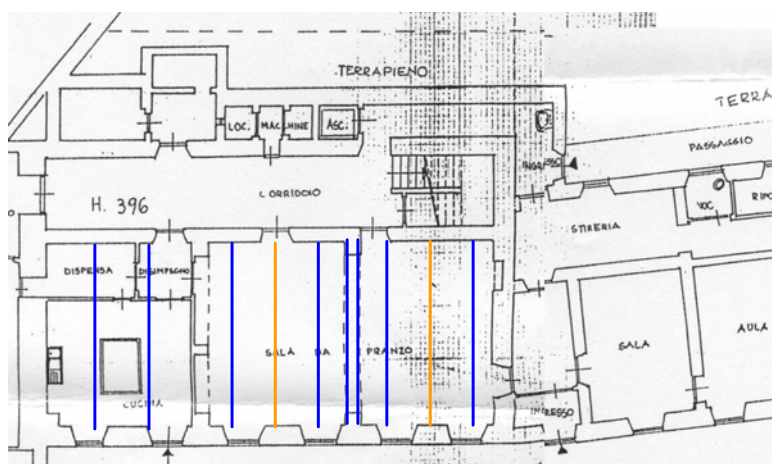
Piano terra – solaio ligneo con travi in acciaio e cemento armato; indicazione qualitativa della posizione delle travi in acciaio (linee blu) e delle travi in c.a. (linee arancioni)
